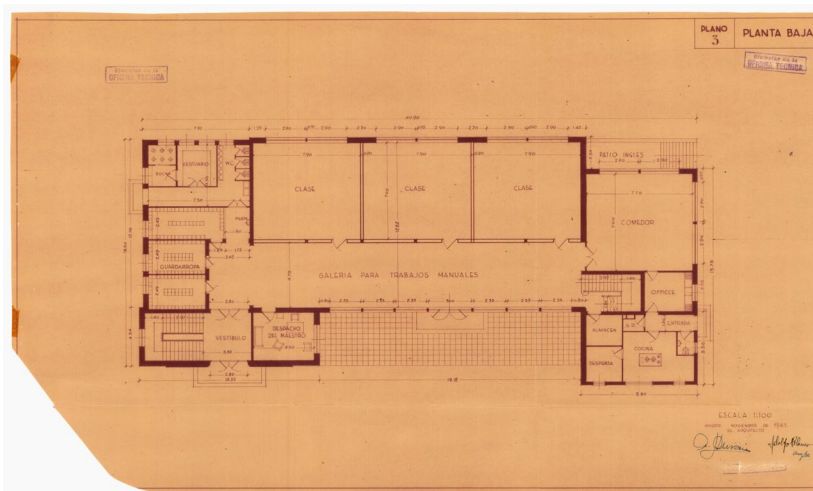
Grupo escolar en calle López de Hoyos (1943). Planta baja.
